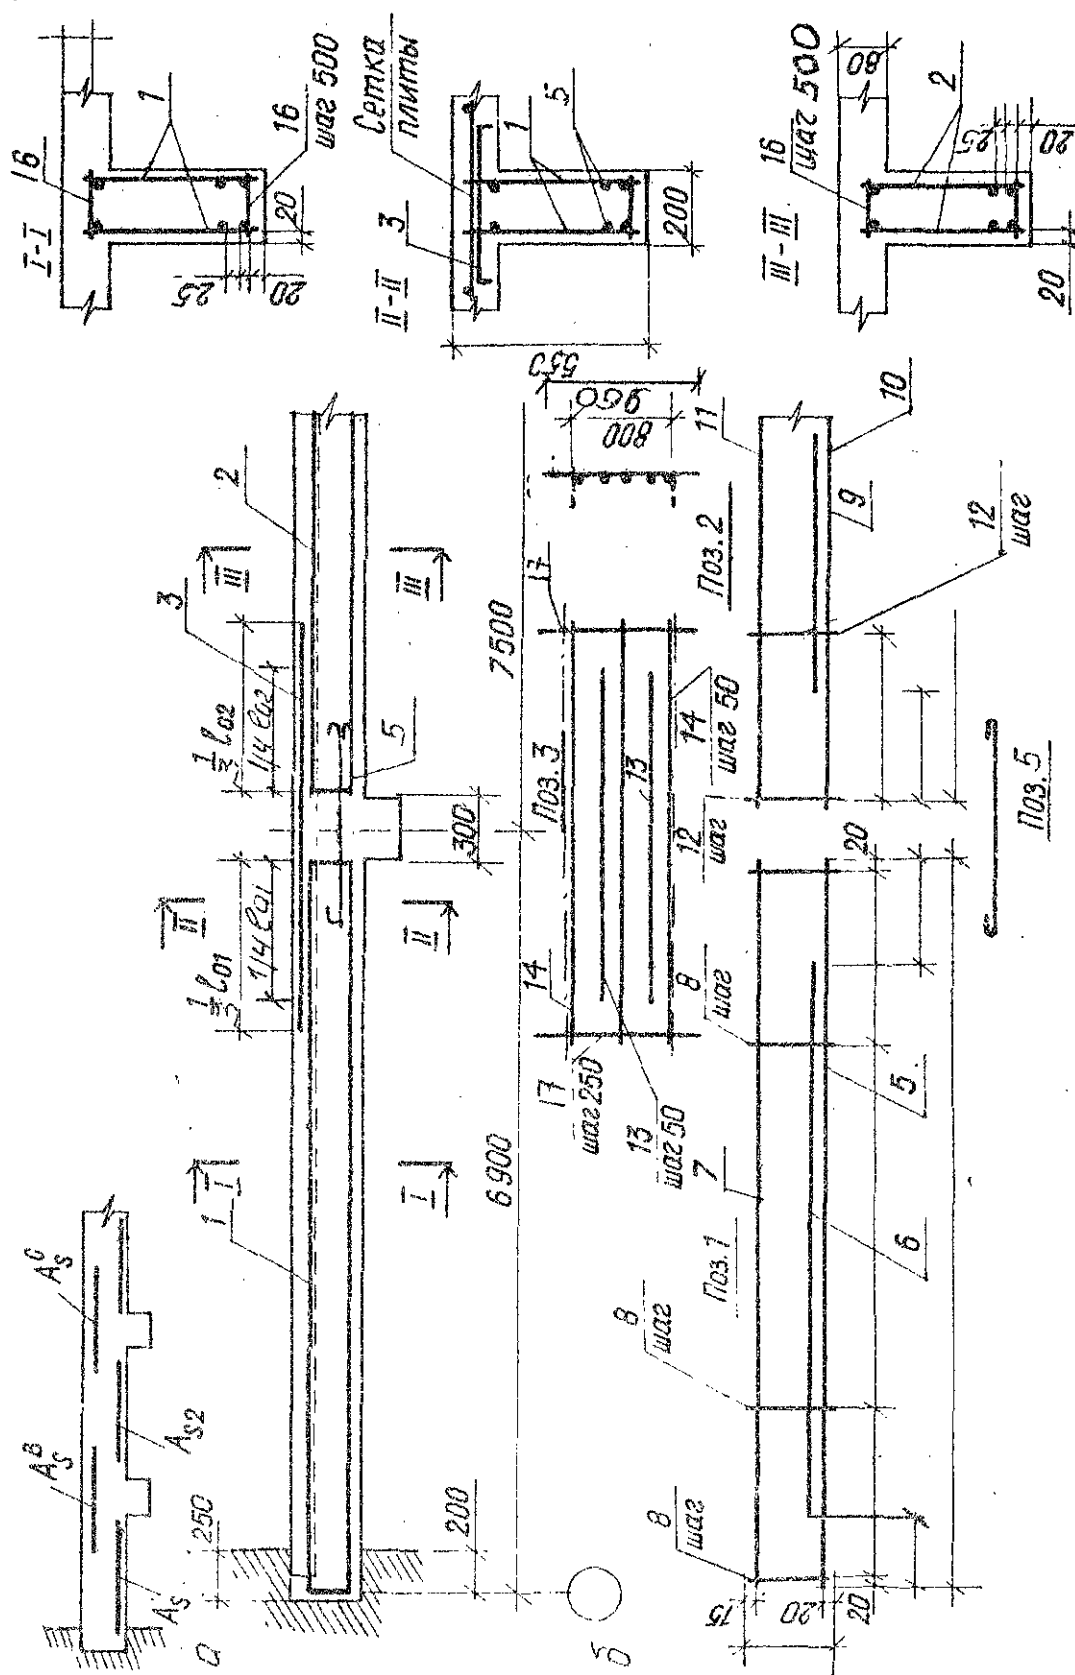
Армирование второстепенной балки сварными каркасами в пролетах и над опорами:
